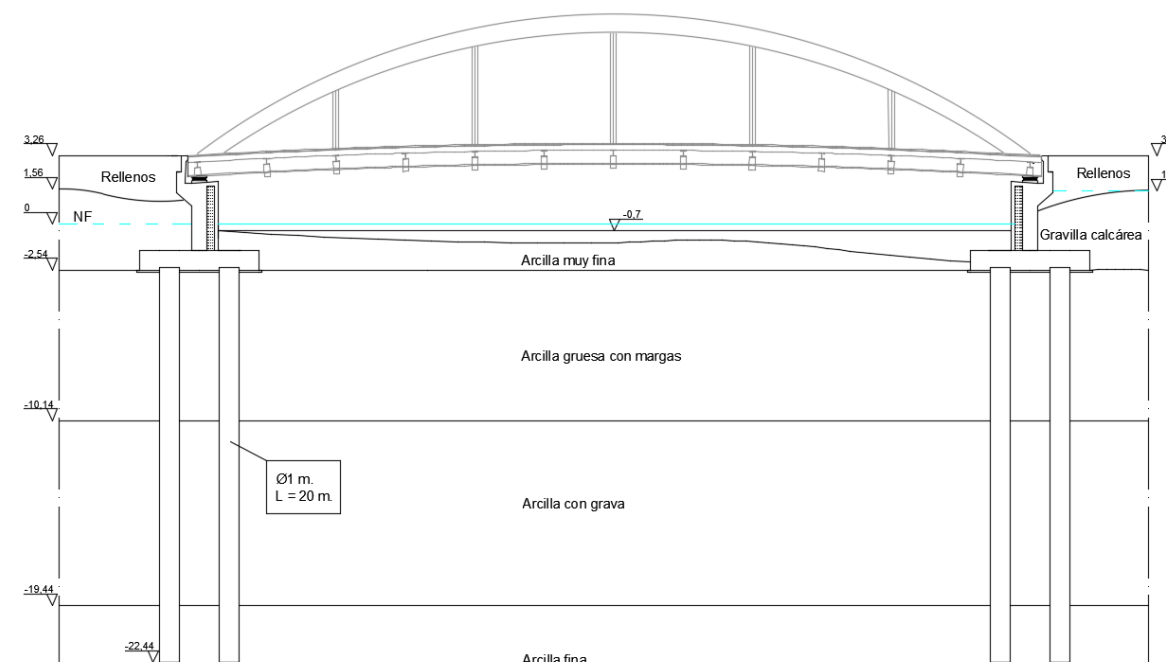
Geología del terreno y solución de subestructura. Elaboración propia con AutoCAD.
